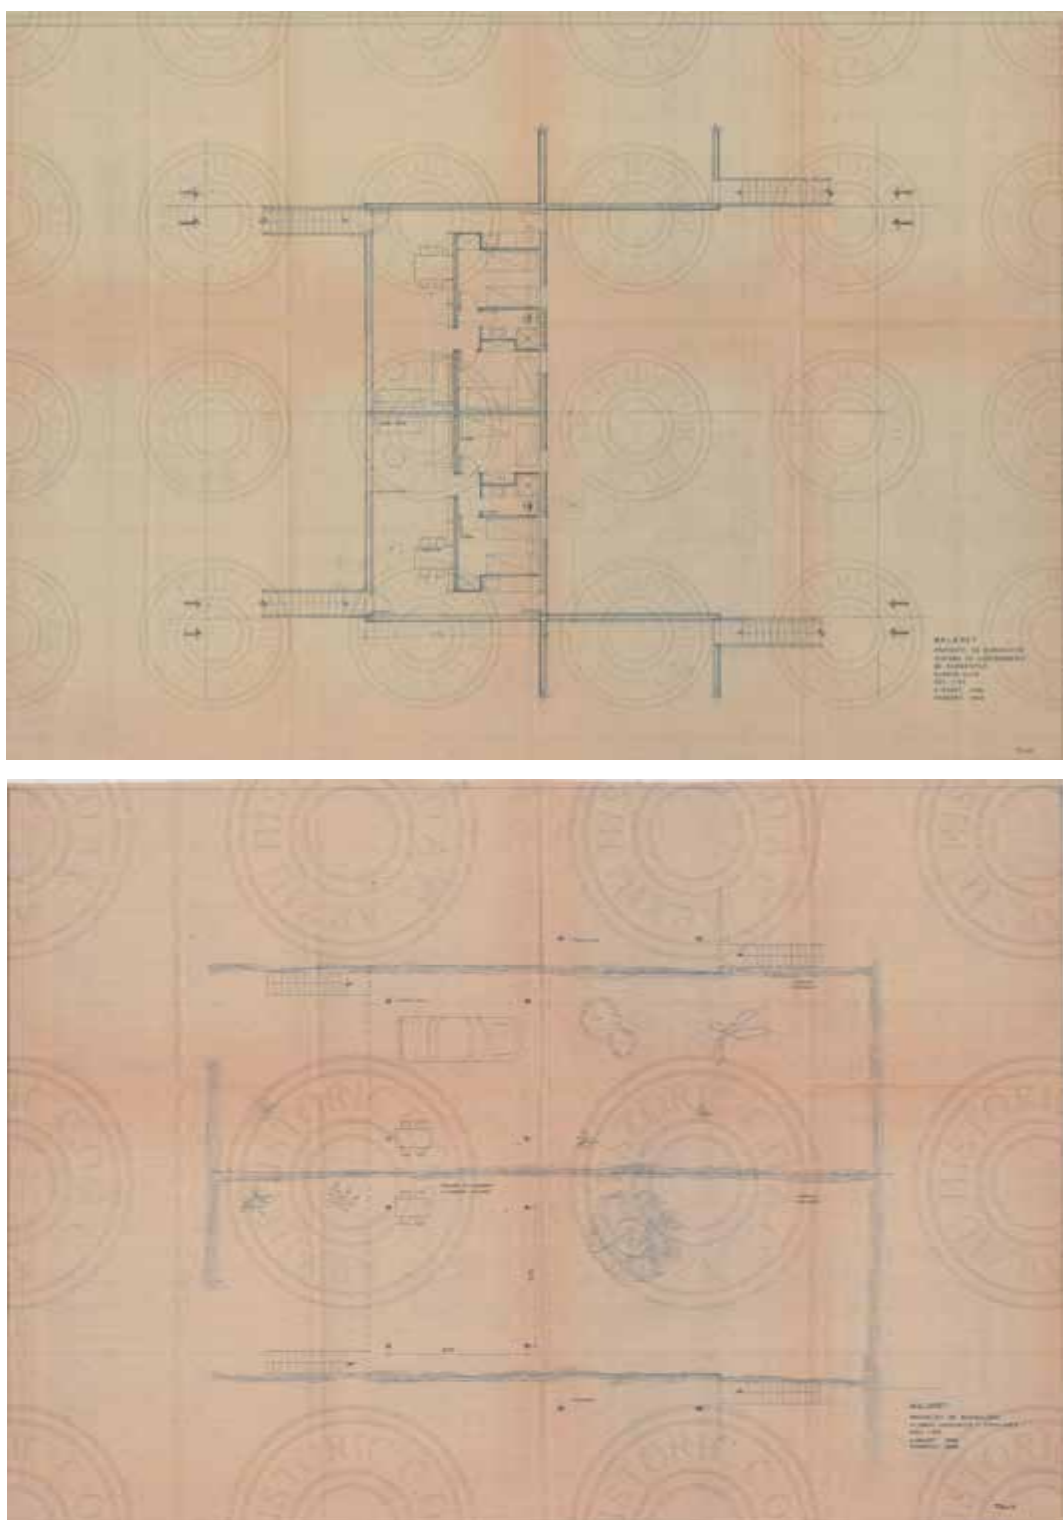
Planos del proyecto original del conjunto Maralet. Planos de planta alta y planta baja. Escala original 1/50. Fecha febrero 1964. Fuente: Arxiu Historic COAC
